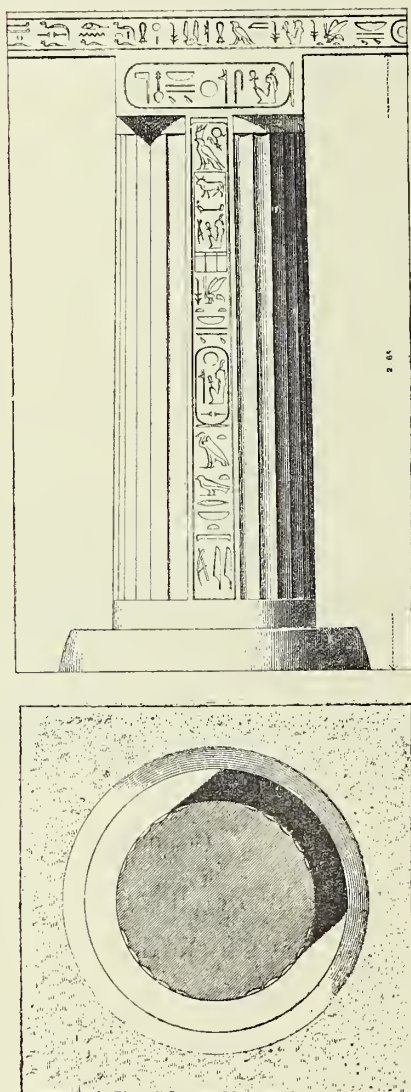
PILAR DE 16 ESTRÍAS Y 4 CARAS PLANAS (KALABCHÉ, XIX DINASTÍA)
